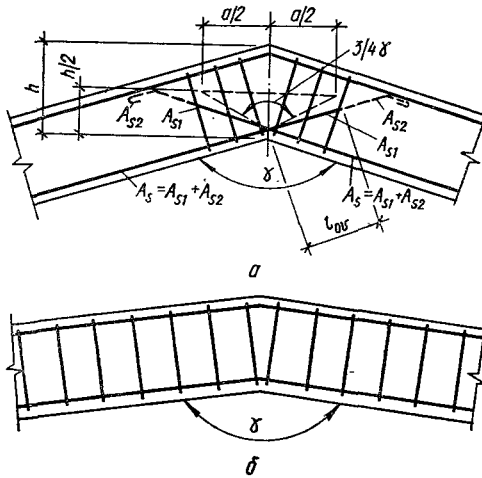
Армирование узлов сопряжения ломаного ригеля:
